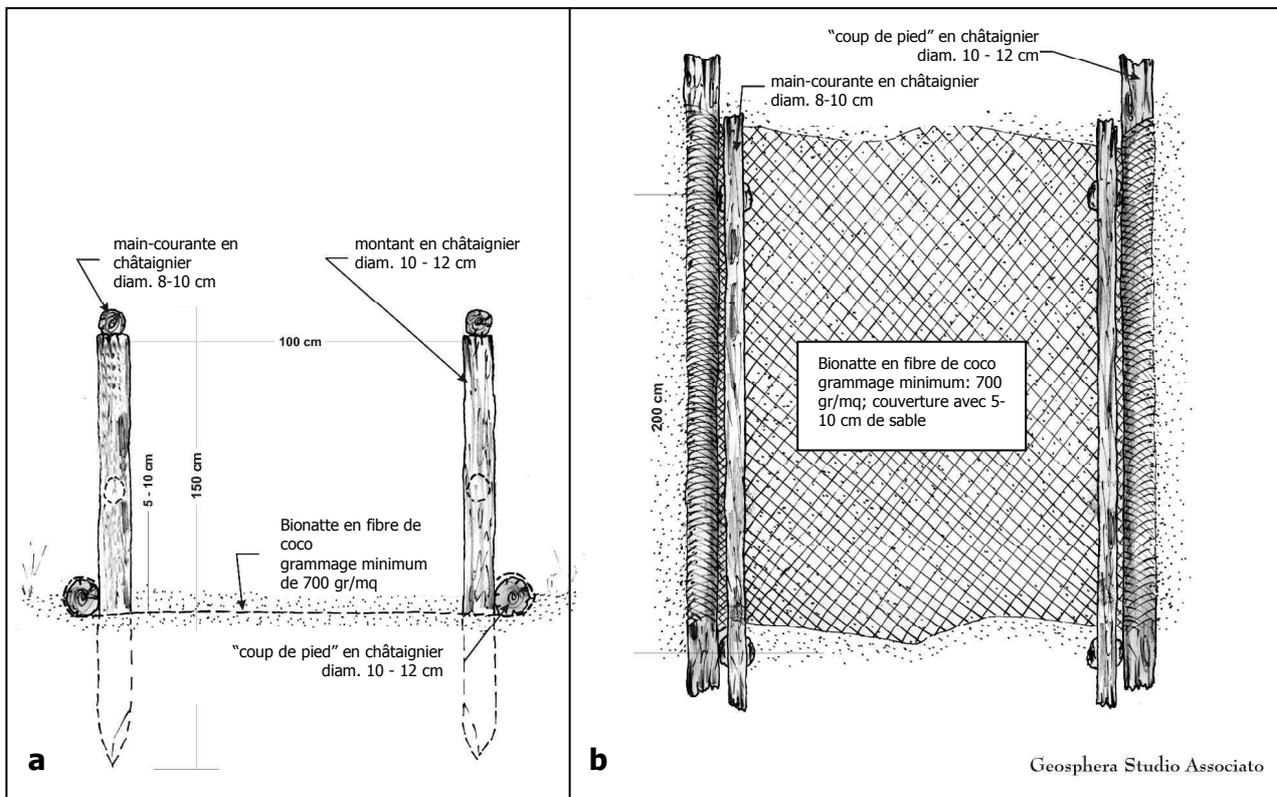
Passerelles rasantes. Légende: a) section; b) plan.
